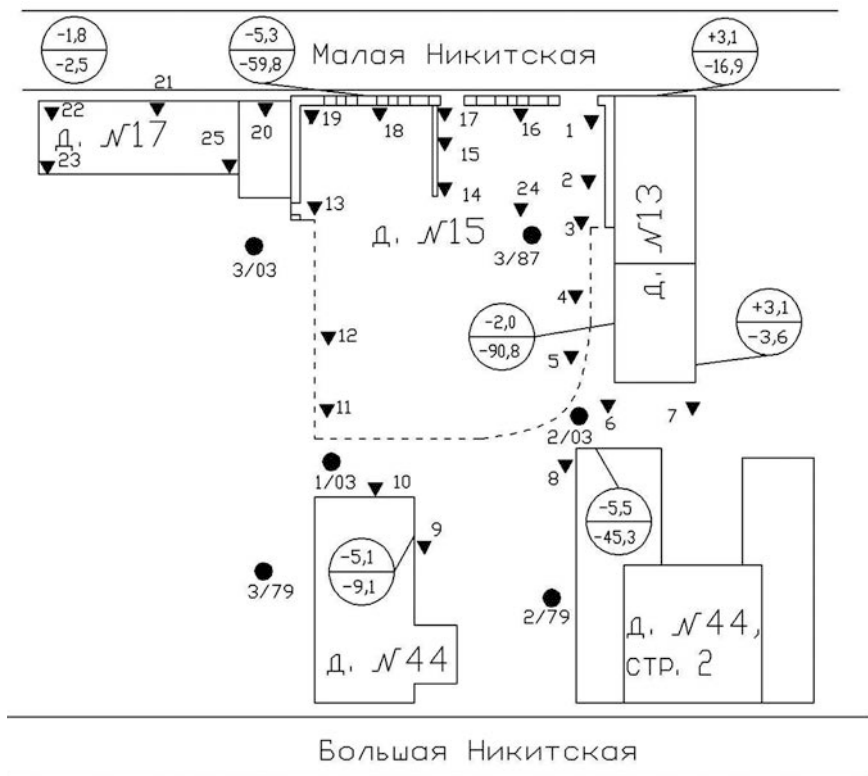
Схема строительной площадки по адресу ул. Малая Никитская, д. 15 с примыкающими к ней зданиями и расположением инженерно-геологических скважин и точек электродинамического зондирования (ЭДЗ):
